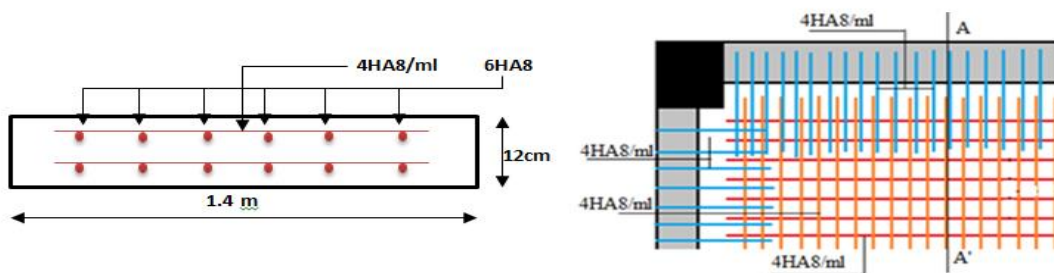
Schéma de ferrailage de la dalle sur deux appuis perpendiculaires.
